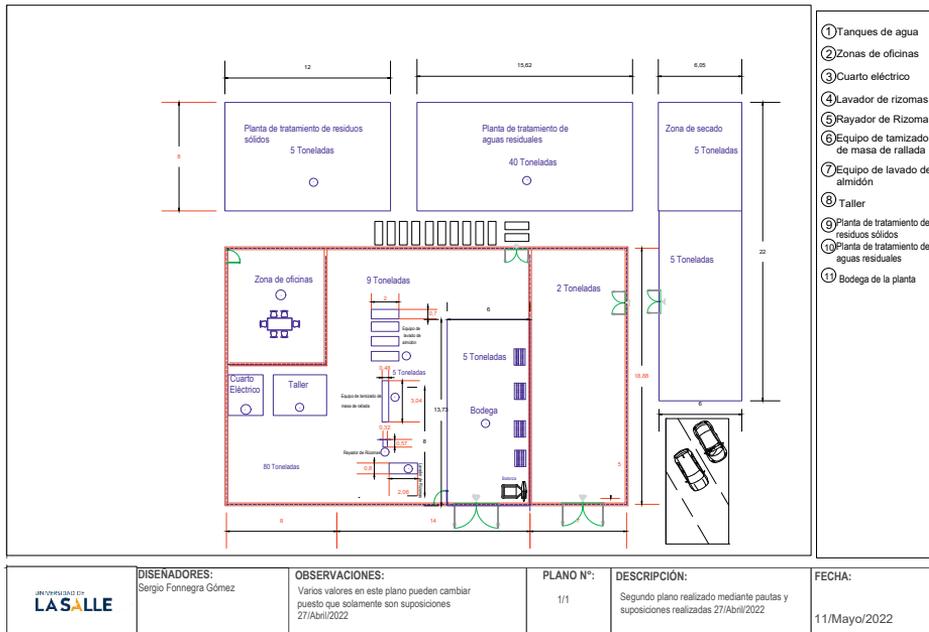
Plano de la nueva planta de producción de almidón propuesta por el grupo de trabajo
